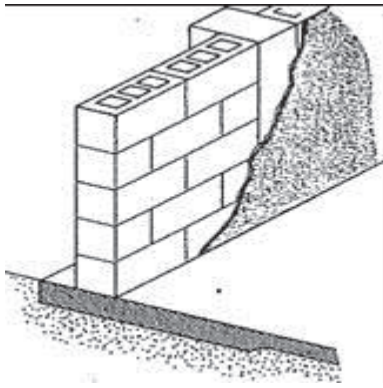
Gewapende betonwanden (tek. C.B.I. 3386).
